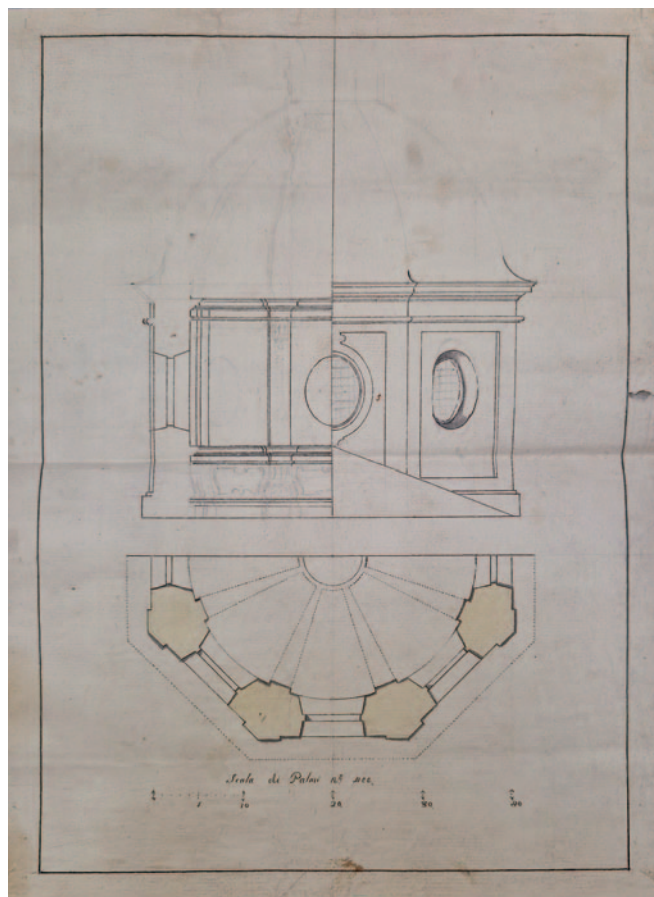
Stefano Ittar, progetto della cupola della chiesa Madre di Adrano, pianta (Adrano, Archivio della Collegiata, carpetta Chiesa Madre. Campanile. Disegni).
